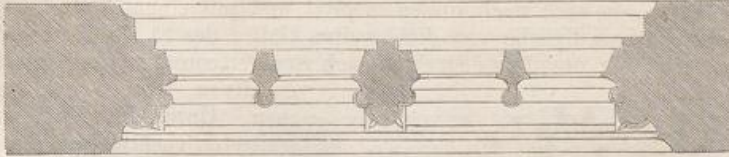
Nikolaikapelle zu Ober-Marsberg. Fenstergrundriss.
